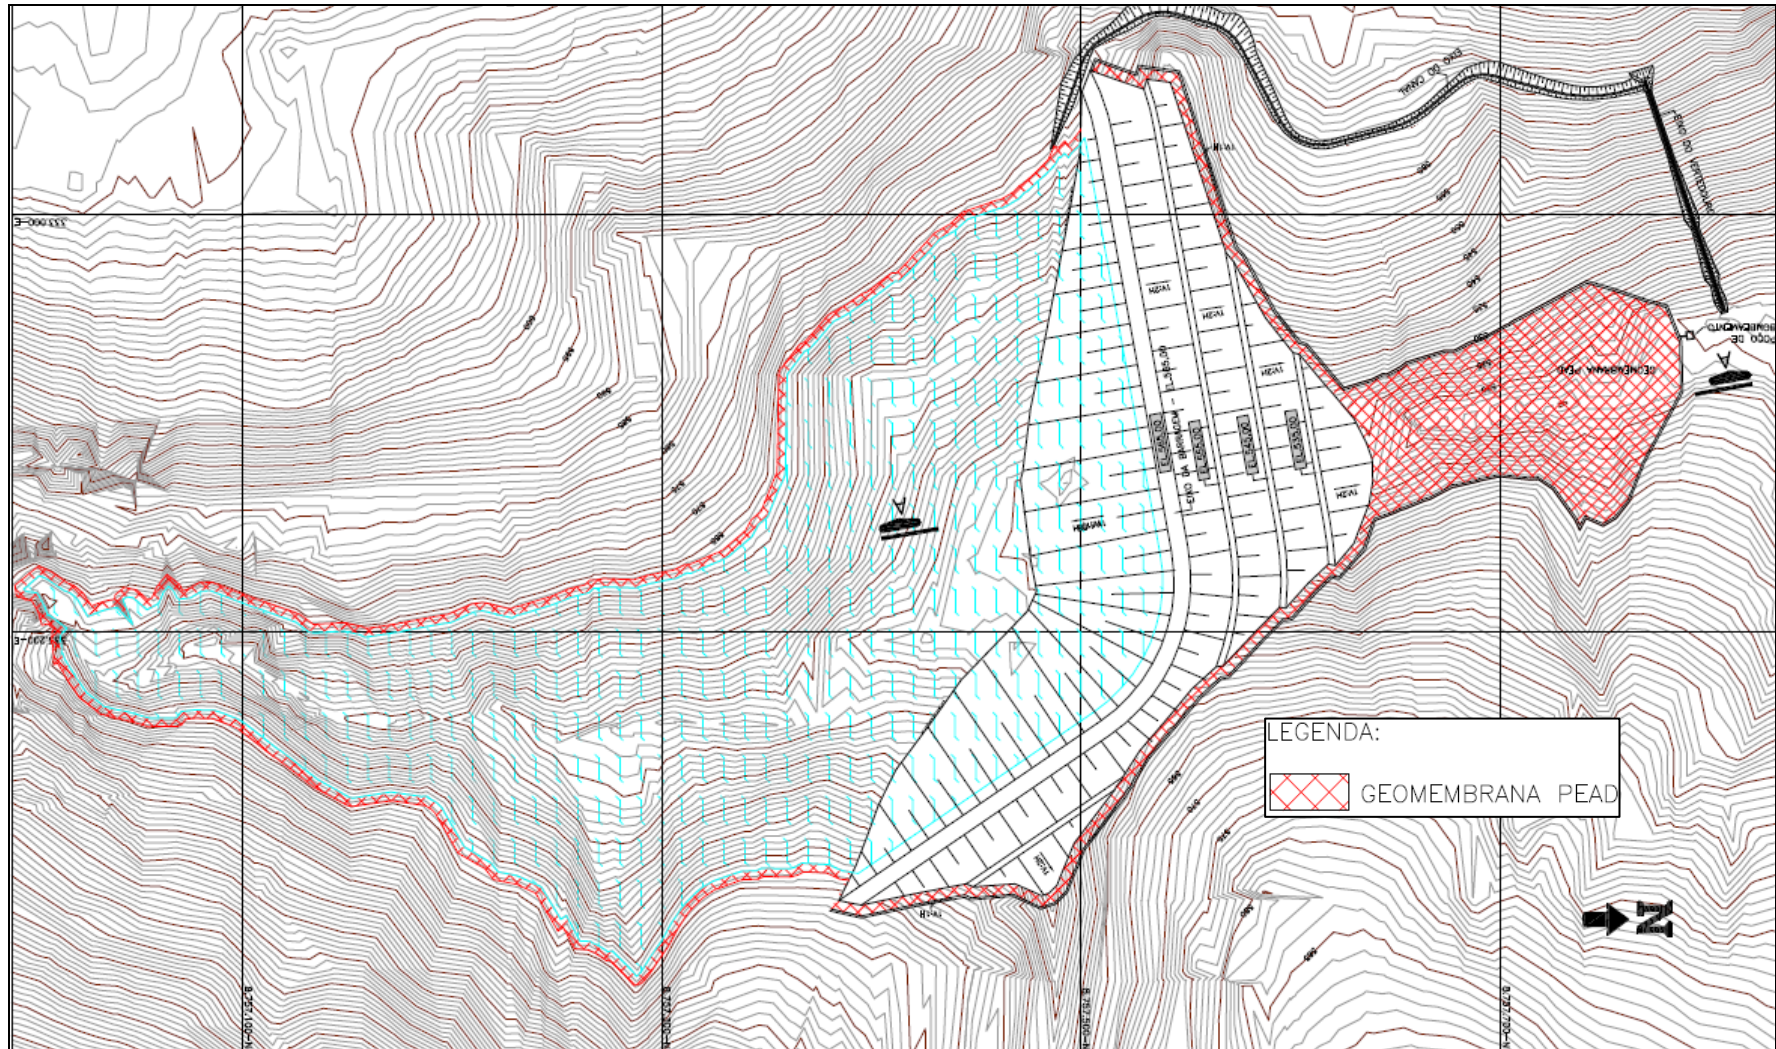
Arranjo geral da barragem de Jacobina 1ª etapa (DAM, 2008).
